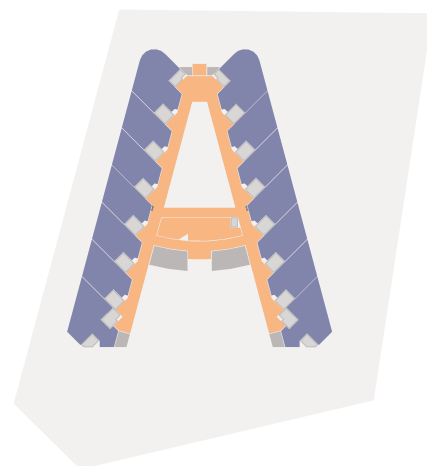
Planta do Quarto Pavimento - Tipo 4.
